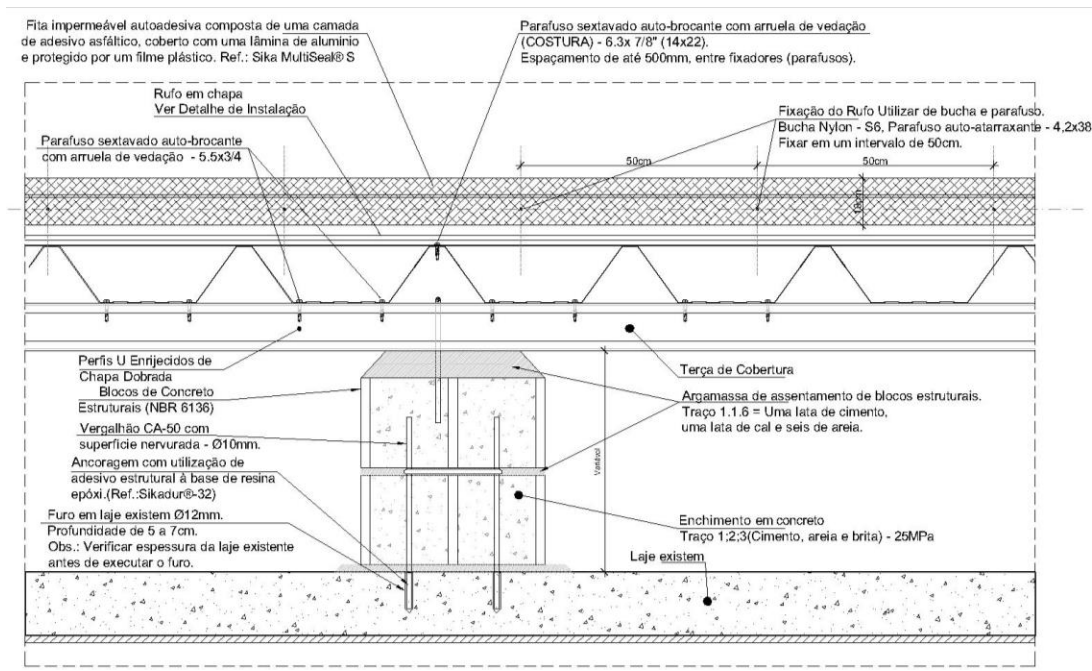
Vista frontal da estrutura de apoio da cobertura
